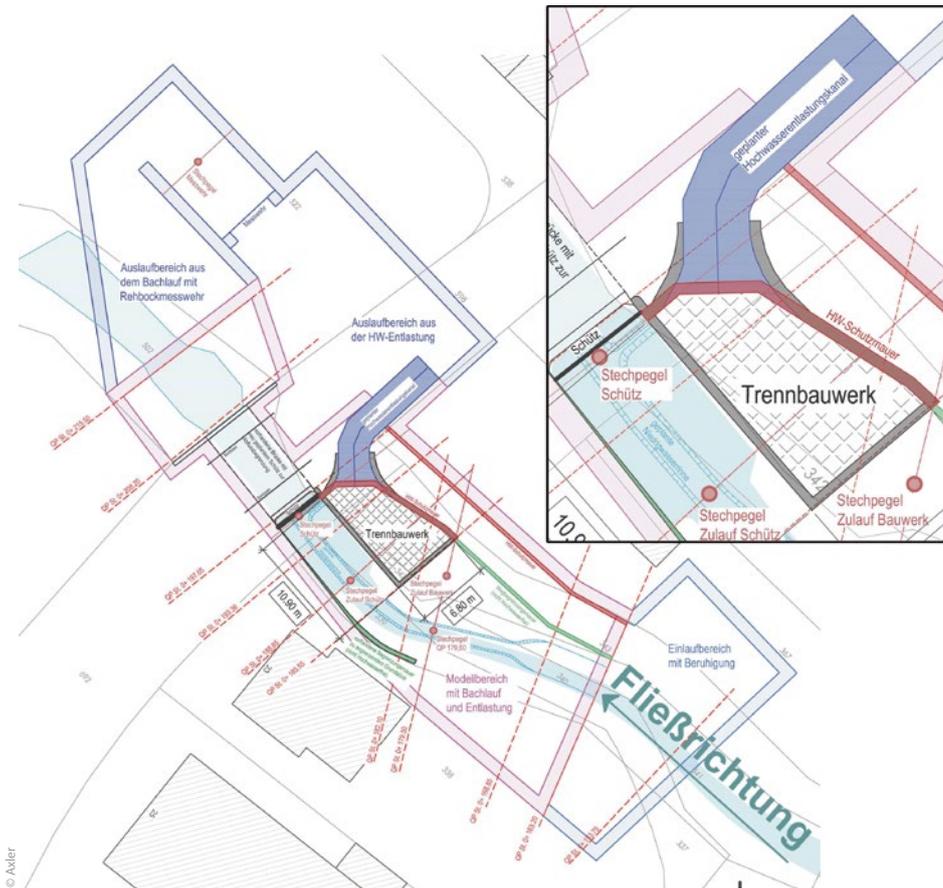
Grundriss des hydraulischen Modells, Übersicht und Detailausschnitt
